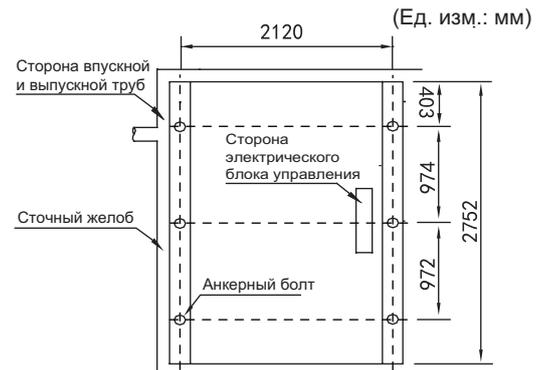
Вид сверху на схематический чертеж с монтажными размерами модели MCDH164A-PR3
